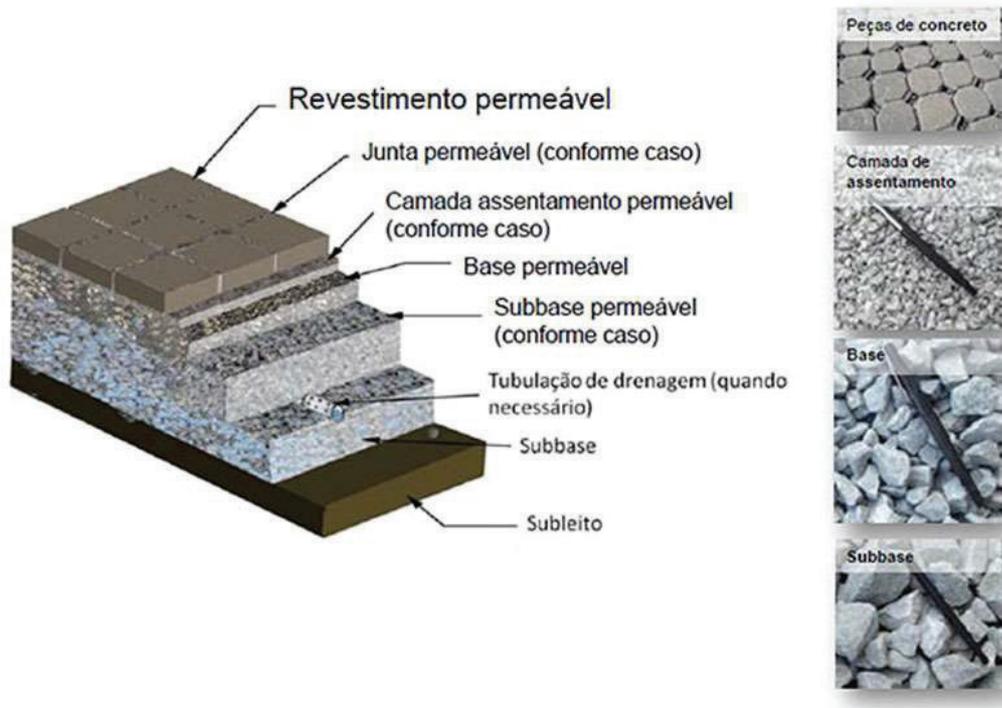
Seção-tipo típica de pavimento intertravado permeável.
